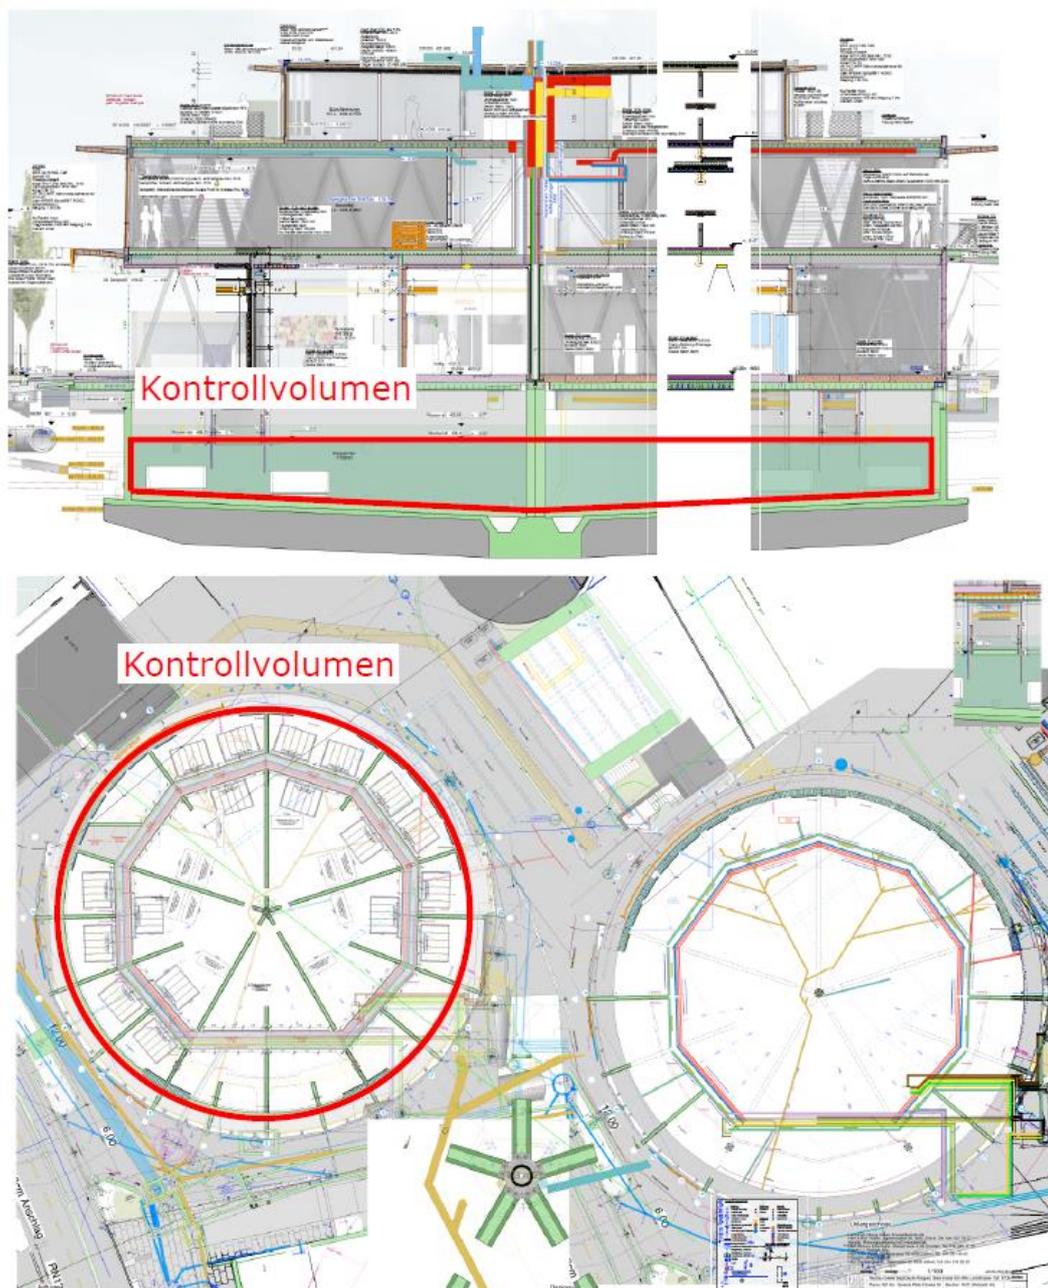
Kontrollvolumen des Eisspeichers für das thermische Eisspeichermodell im Querschnitt und Grundriss
